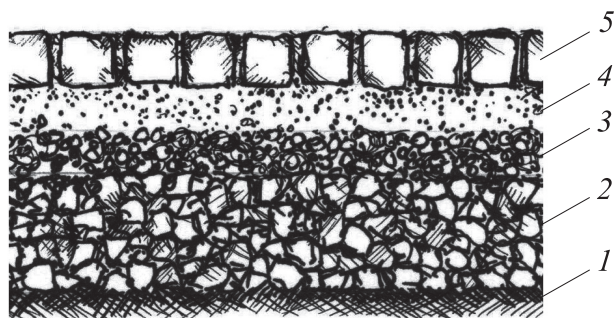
Конструкция покрытия из брусчатки колотой на основании из щебня: 1 — грунтовое основание; 2 — несущее основание (крупный щебень); 3 — несущее основание (средний щебень); 4 — слой, связывающий основание и верхнее покрытие; 5 — брусчатка 10×10×10 см
